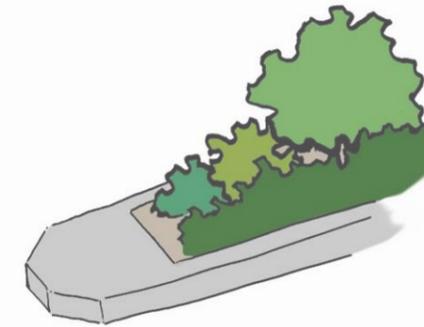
Traitement minéral des espaces trop restreints pour planter, Source : Ingérop
